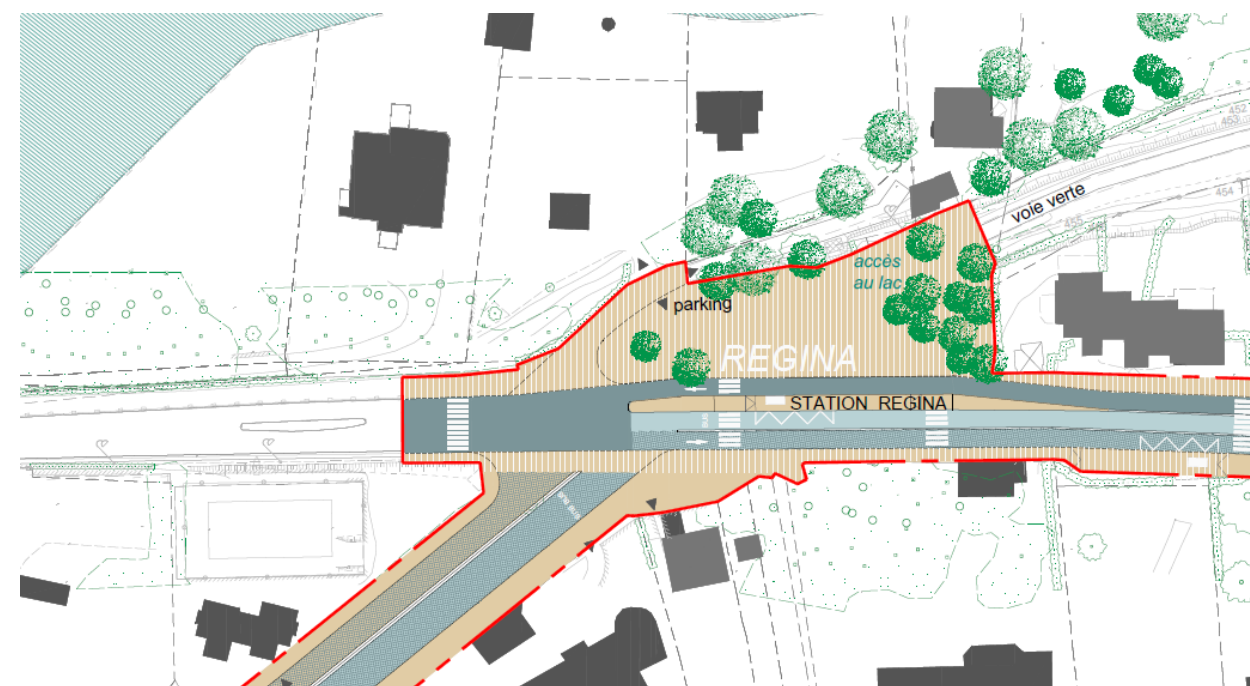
Plan masse : Aménagement du centre de la commune, Sévrier (Source : Ville de Sévrier)
